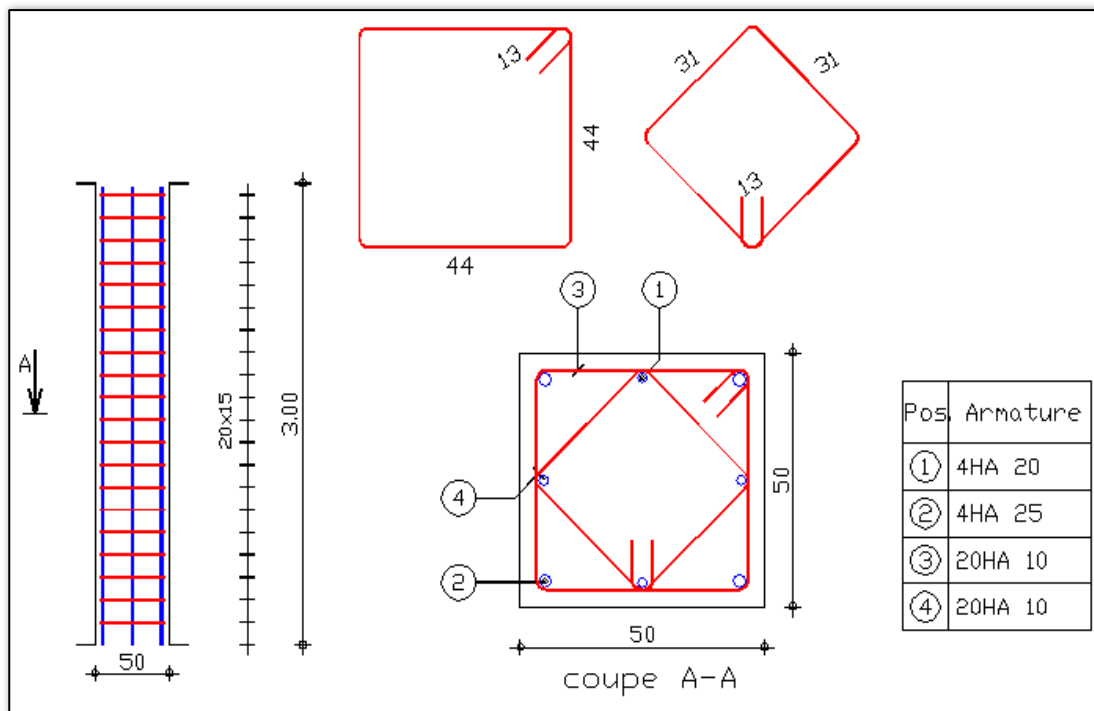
schéma de Ferrailage du poteau selon le C.B.A. 93
